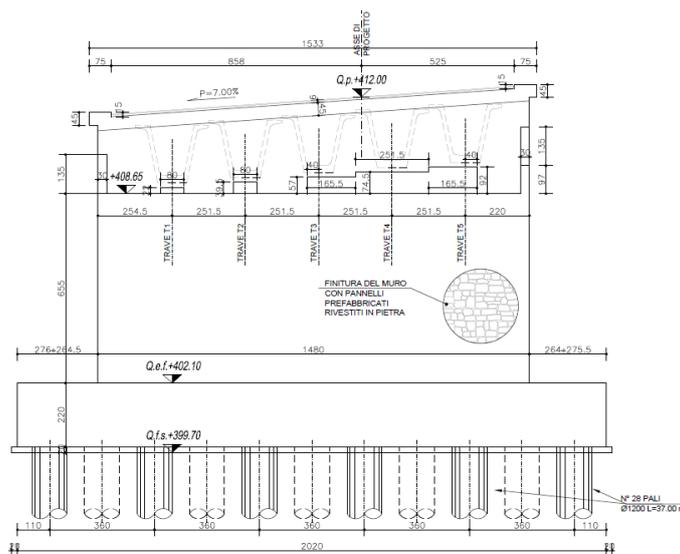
VISTA FRONTALE SPALLA SP1 VIADOTTO ASSINO 2
